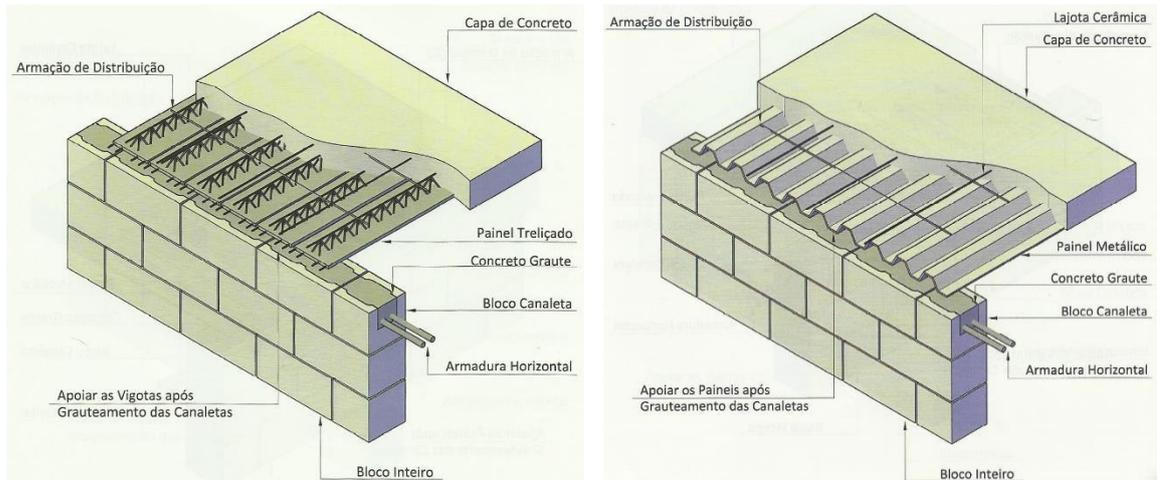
Processo de construção de laje em painel treliçado e de laje em steel deck, respectivamente. Fonte: NESE e TAUIL, 2010, montagem da autora.
